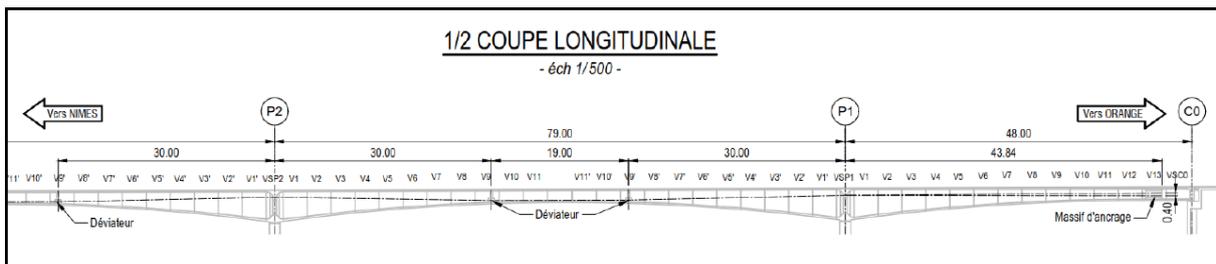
Illustration d'un massif d'ancrage et d'un déviateur de câbles de précontrainte à mettre en place à l'intérieur des caissons (Photo : Naturalia)
